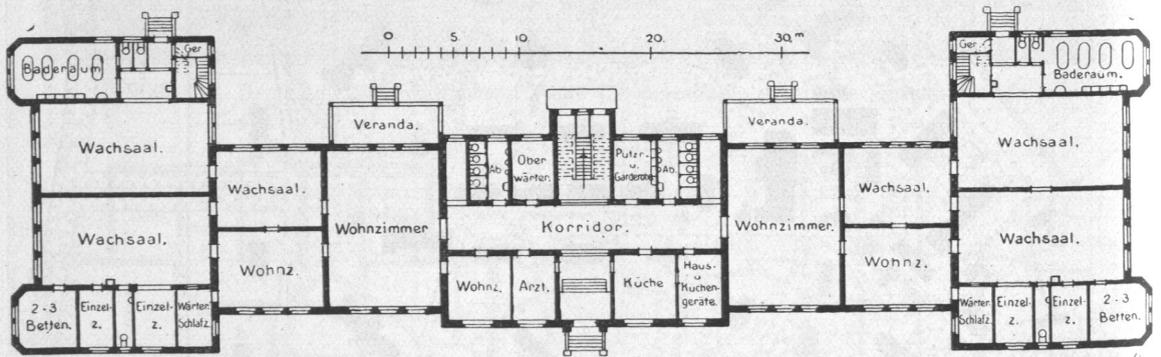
Irrenanstalt Langenhorn, Pflegehaus für 150 Männer und 18 Wärter, Erdgeschoß, Grundriß.
